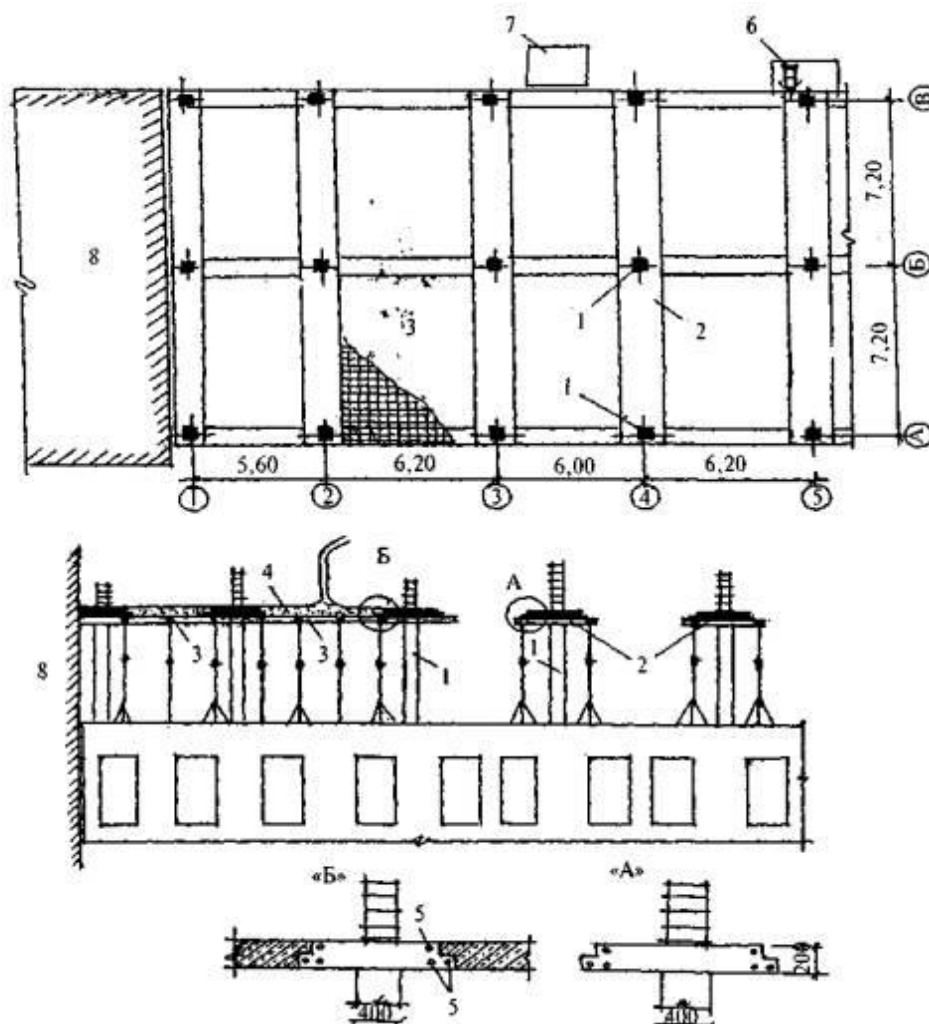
Технологическая схема надстройки зданий с использованием каркаса с преднапряженными плоскими ригелями
